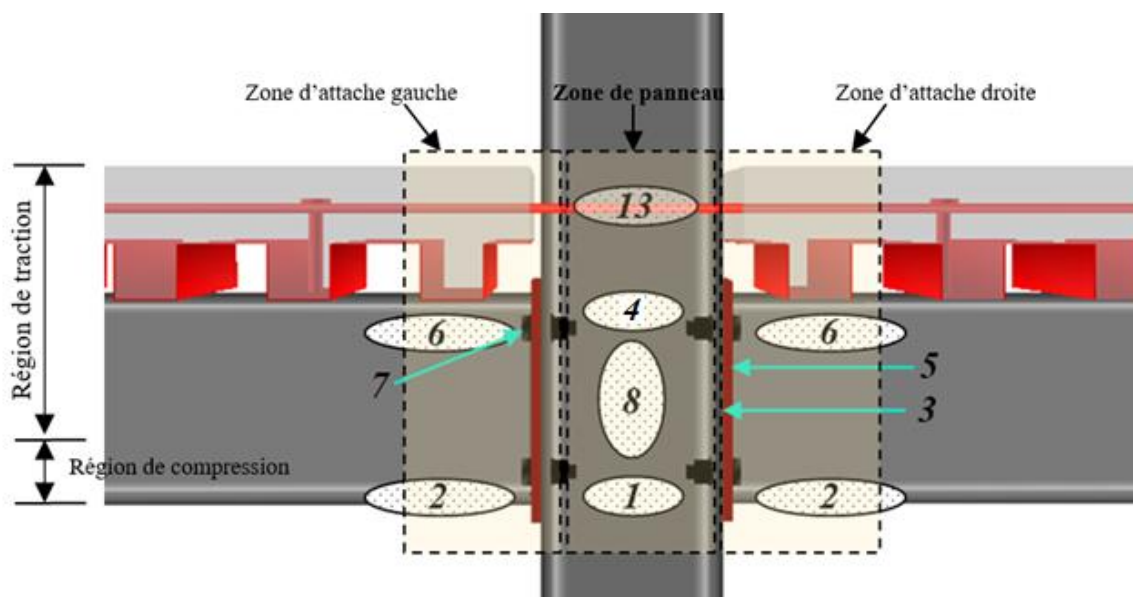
Régions et zones d'un assemblage mixte type poutre-poteau
